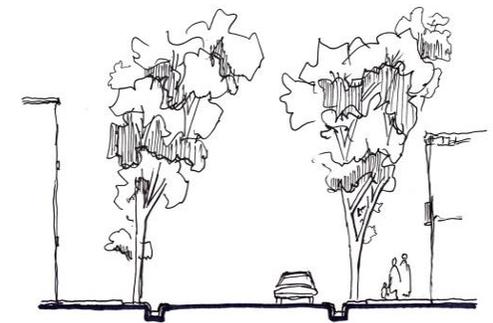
Perfil calle de Mendoza. Fuente: Foto de Street View, google Earth 2015. Corte esquemático de elaboración propia.
